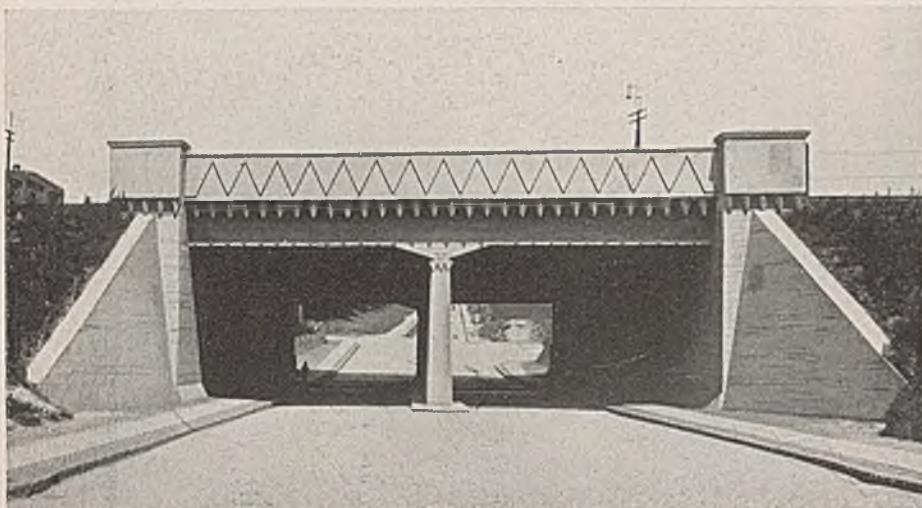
Eisenbetonbalkenbrücke mit geraden, geneigten Schräglügeln.
